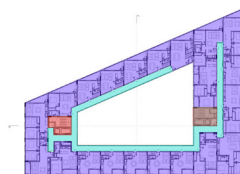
Planta nivel 3. Fuente: Archdaily, 2018.
